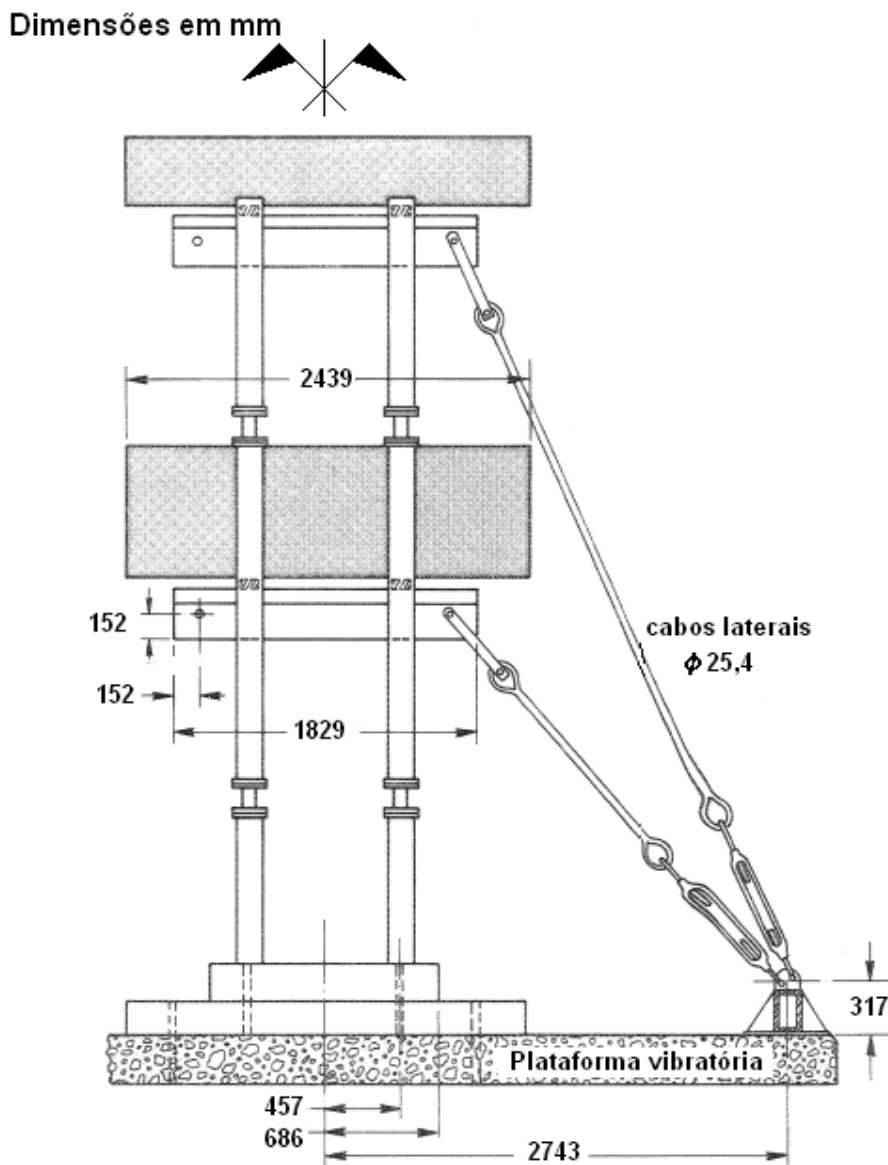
Vista transversal do pórtico, CLOUGH & GIDWANI (1976)
